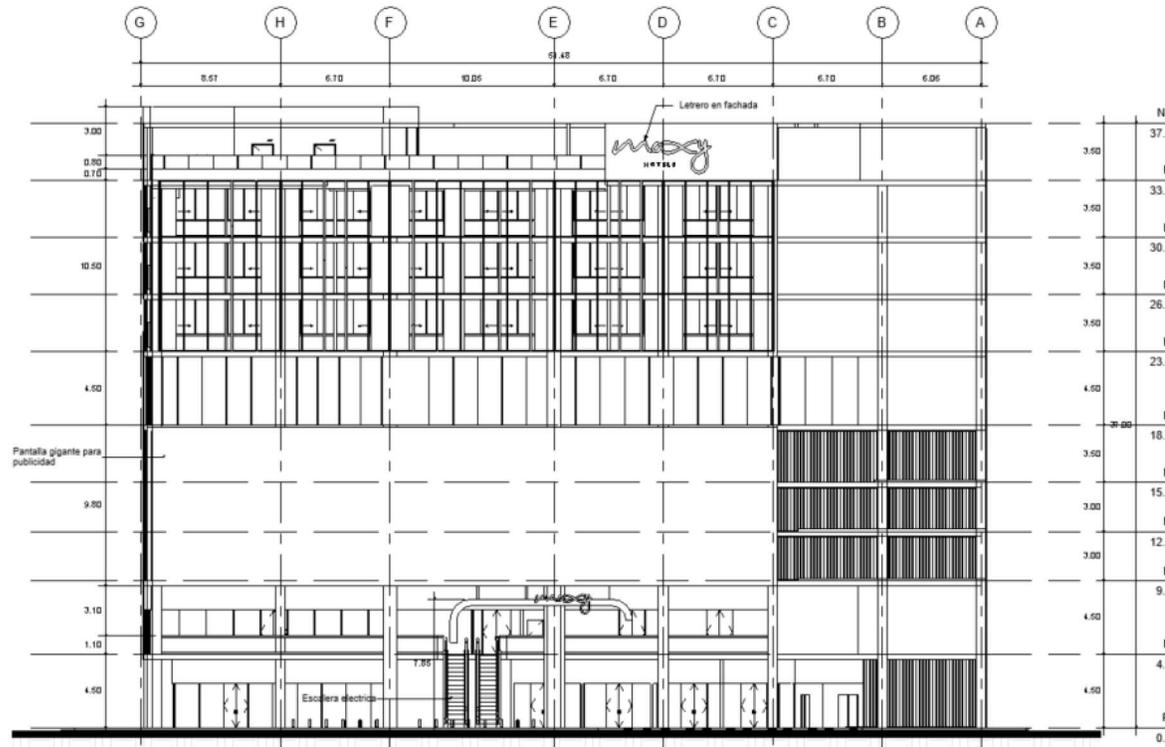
Alzado arquitectónico norte (Fachada del proyecto).
